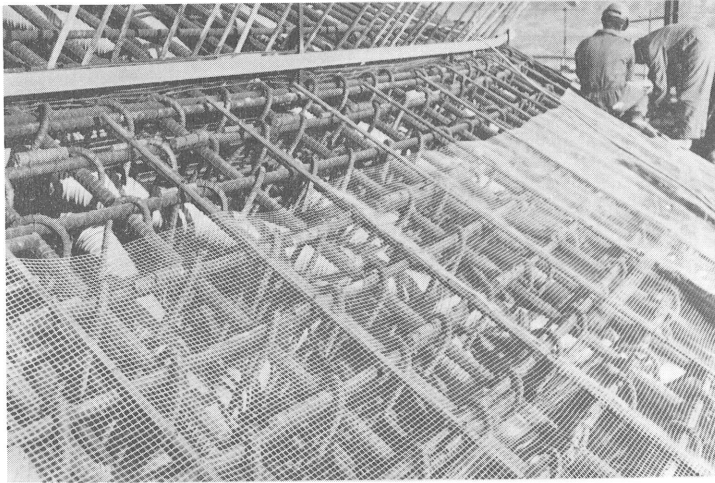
Fases de hormigonado de la viga-anillo de la cúpula.
